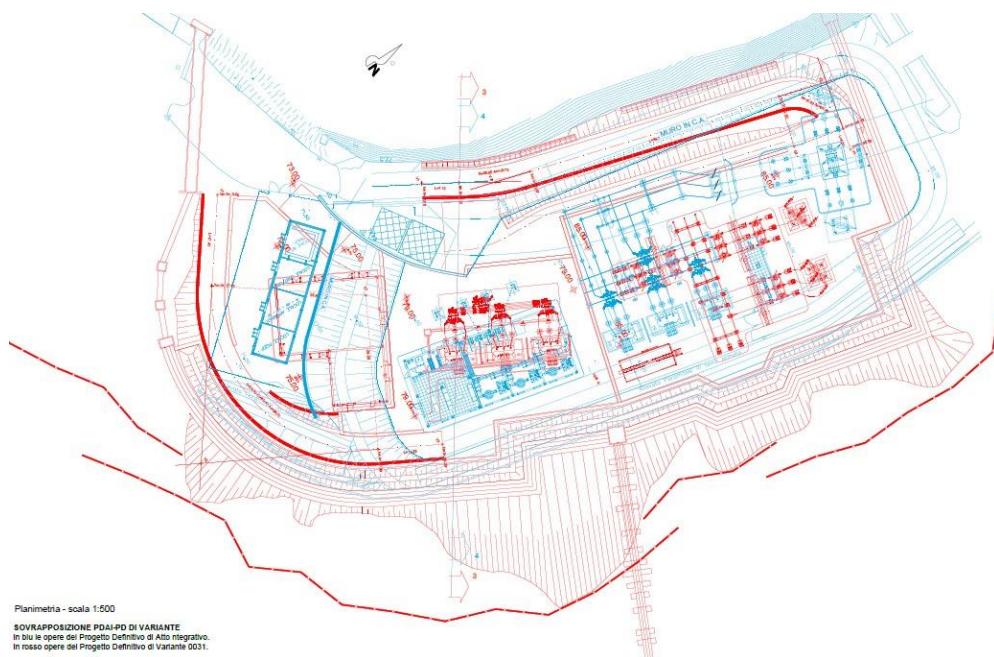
Piazzola IN21 – Planimetria di confronto tra progetto approvato (blu) e progetto in variante (rosso)
